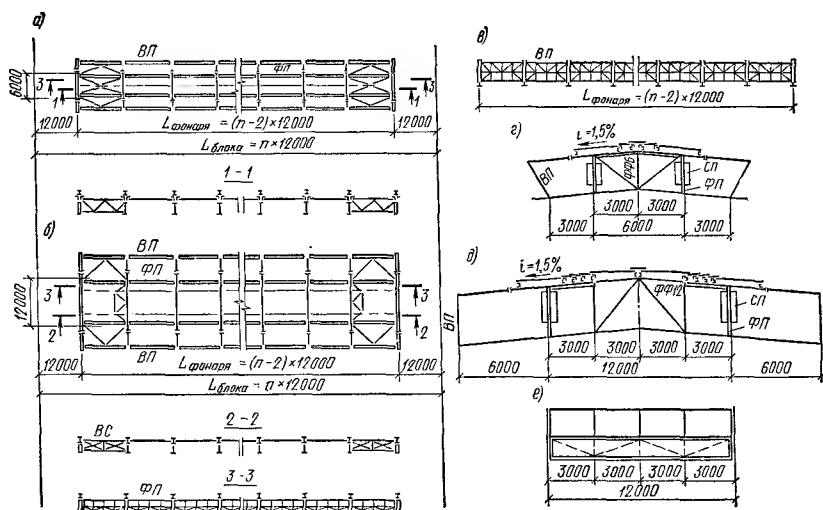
Аэрационные фонари с применением стальных щитов покрытия при шаге стропильных ферм 12 м
